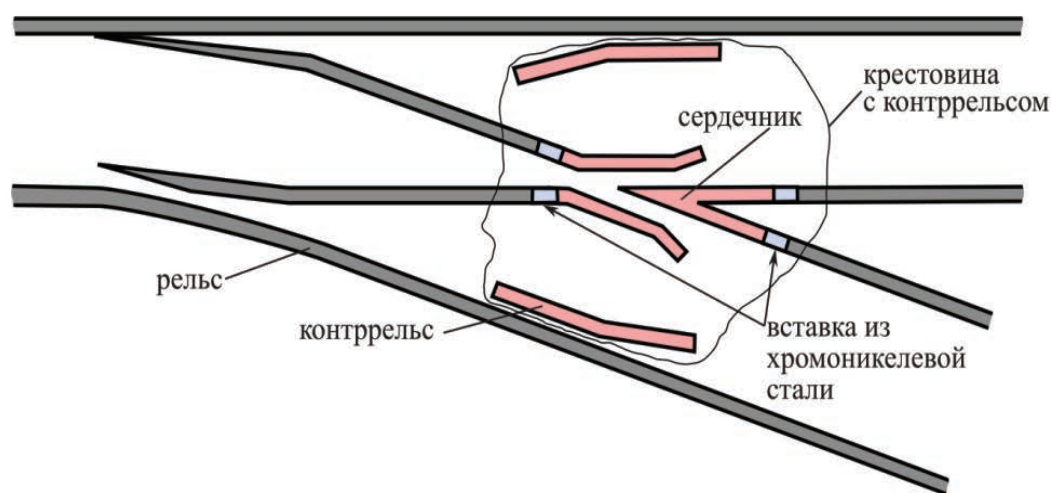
Схема стрелочного перевода со сварной железнодорожной крестовиной
